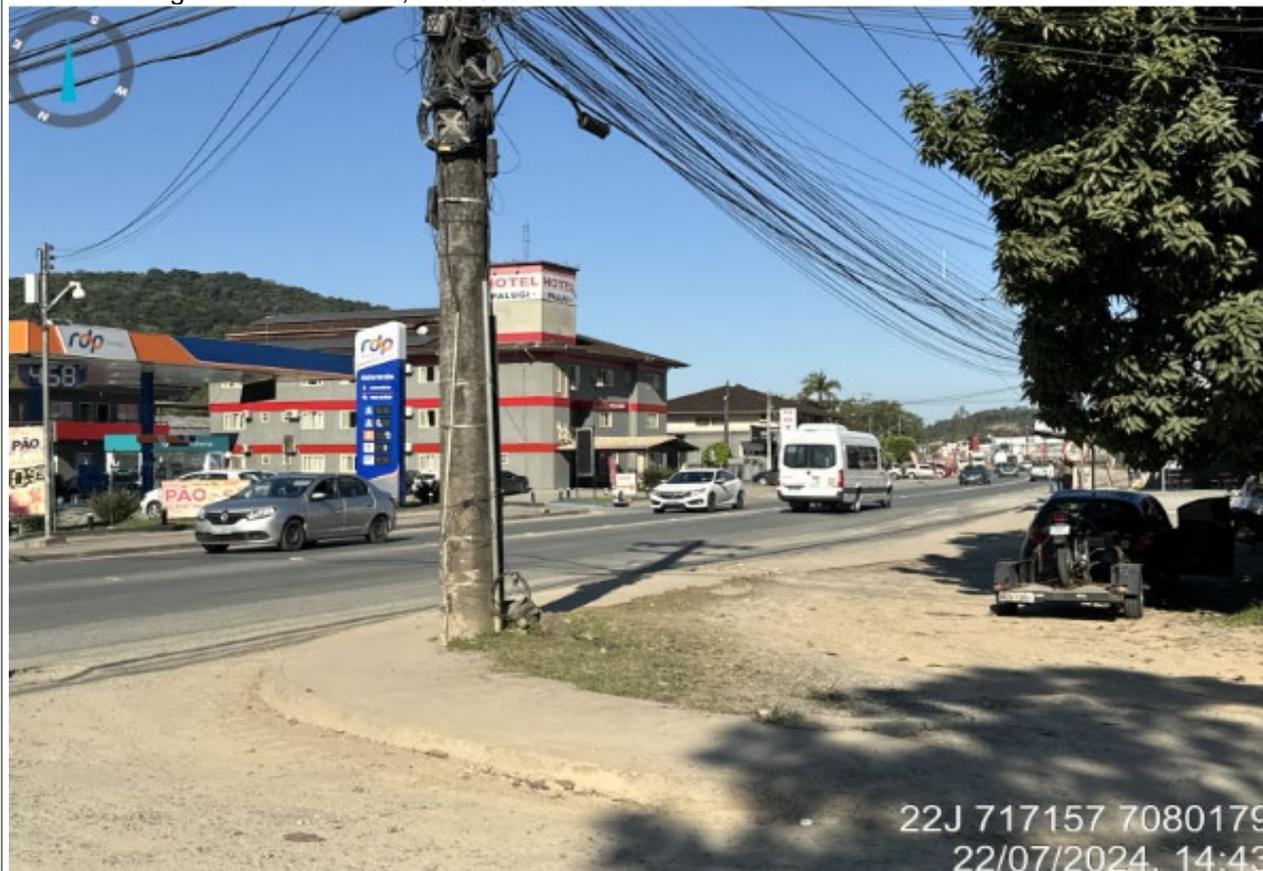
Pavimentação na rua Waldemiro Jose Borges. Fonte: Falmex, 2024.
